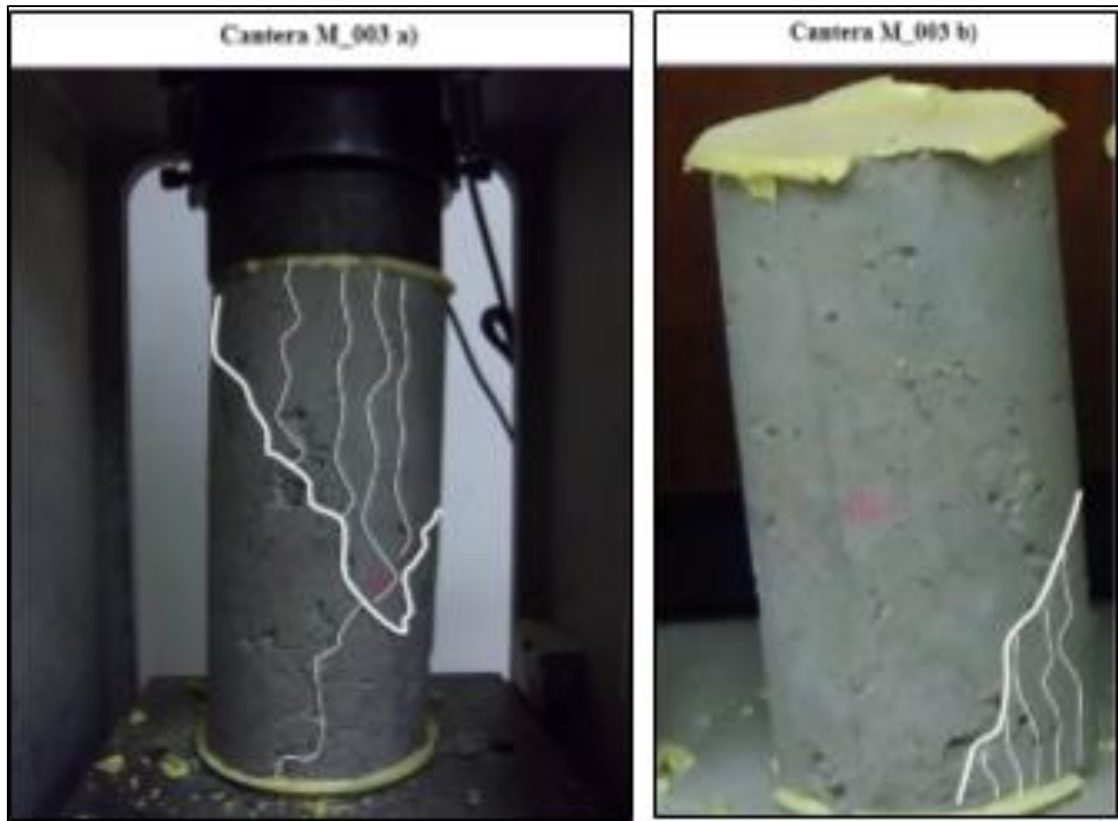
Rotura de fallas. a) tipo 4 y b) tipo 5.
